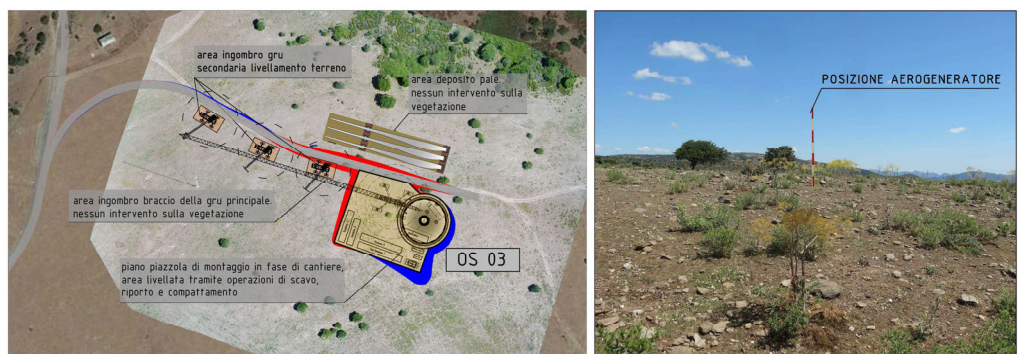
ingombri di cantiere su foto area e foto wtg OS 03
